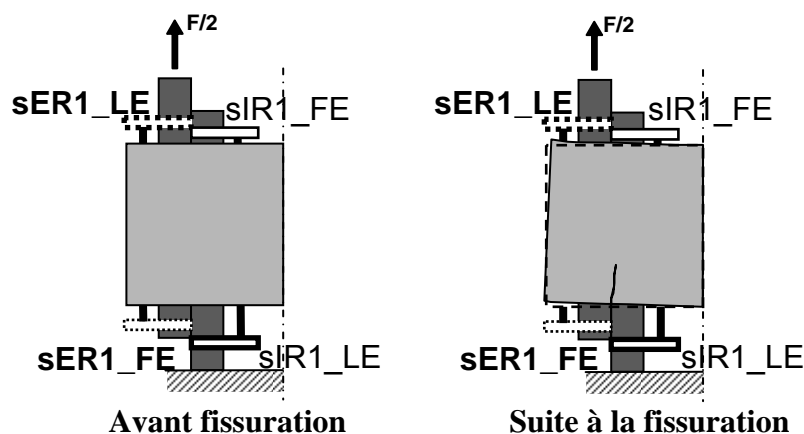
Influence de la fissuration sur la prise de lecture du glissement des barres extérieures
